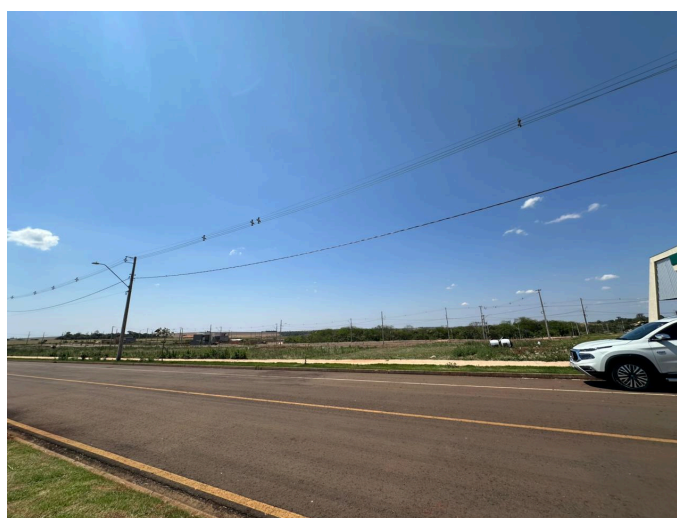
VISTA 2 FACHADA SUDOESTE
